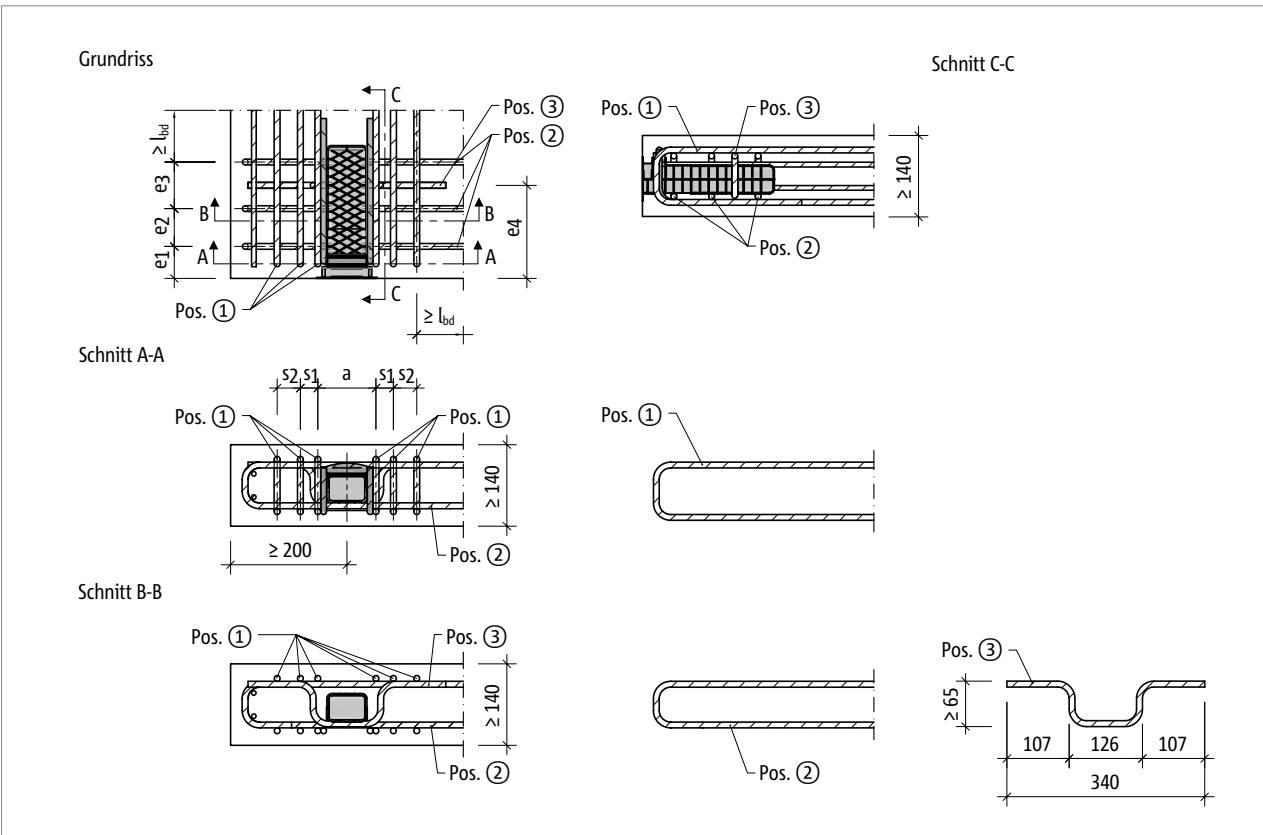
Tronsole® Q: Bauseitige Bewehrung
